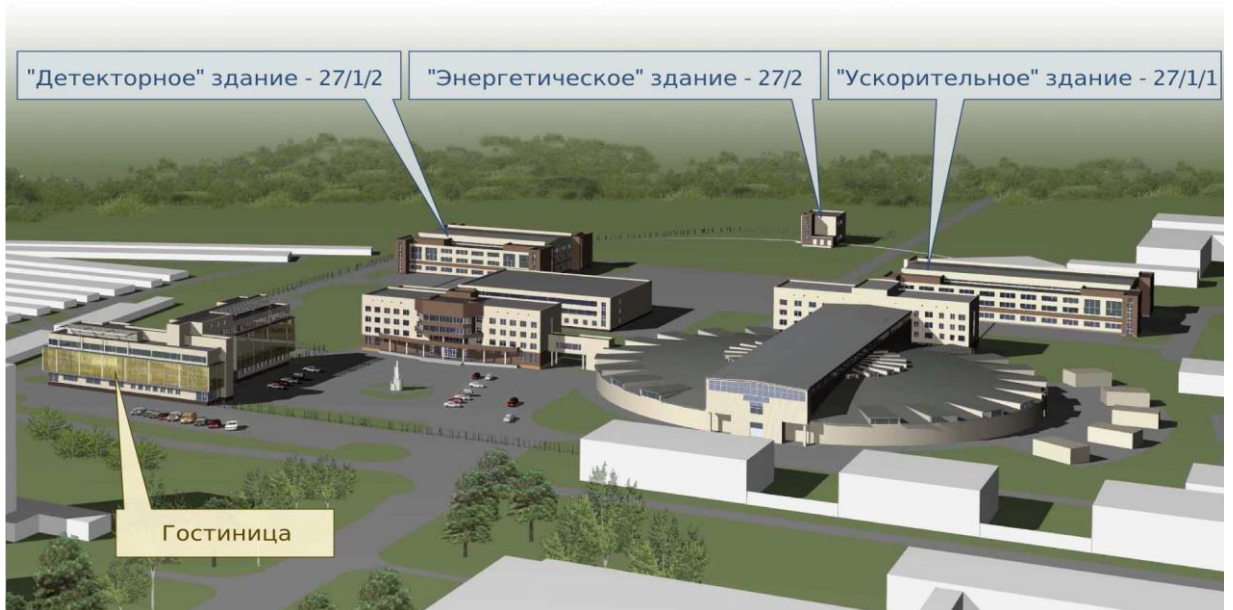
Здания С-тау фабрики комплекса ВЭПП-5 (план развития)
